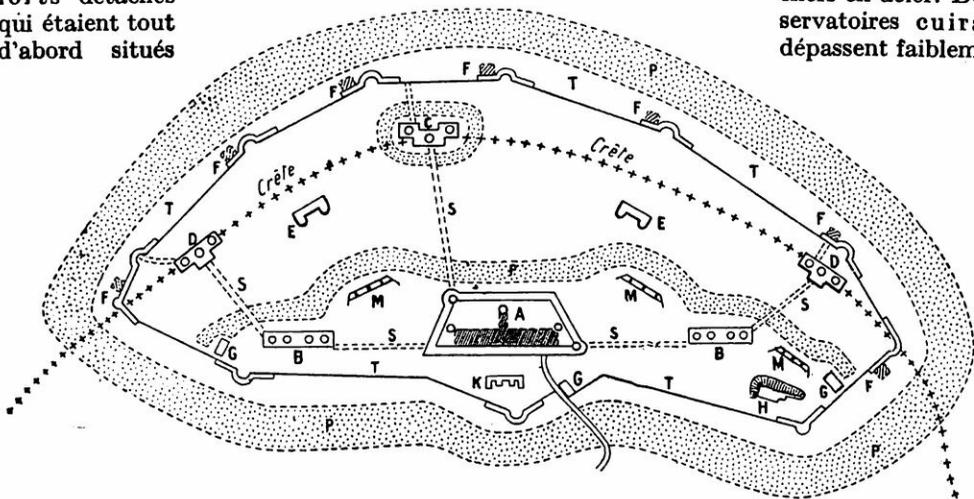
PLAN DE LA FORTERESSE TYPE, D'APRÈS LE GÉNÉRAL X...
